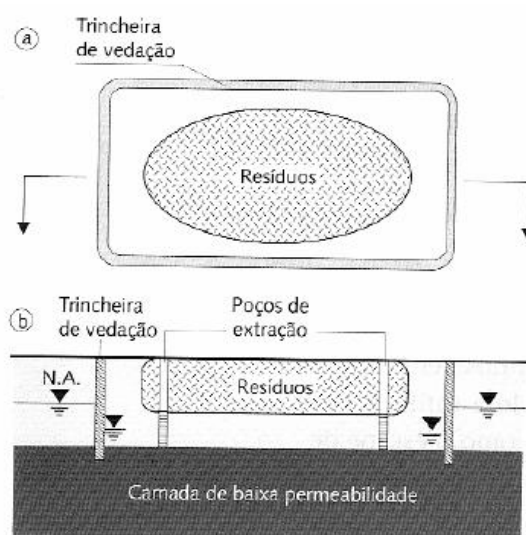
Configuração típica de barreiras verticais para remediação: (a) planta; (b) seção transversal. (Fonte: BOSCOV, 2008)
